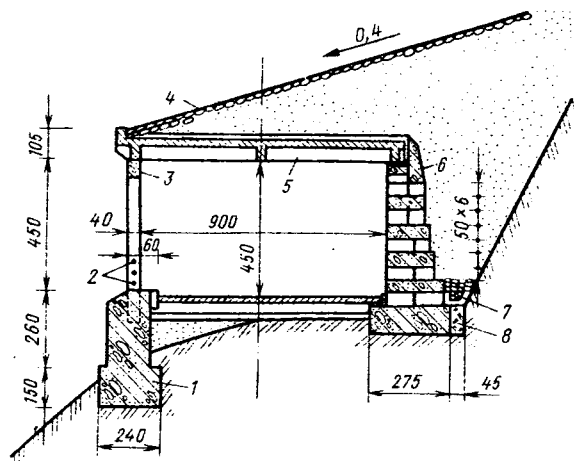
Поперечный разрез галереи «Гудаурские навесы»: 1 — фундамент низовой опоры; 2 — перила; 3 — ригель; 4 — мощение каменное; 5 — плита перекрытия; 6 — блок шкафной; 7 — лоток застенный водоотводный; 8 — глина мятая
